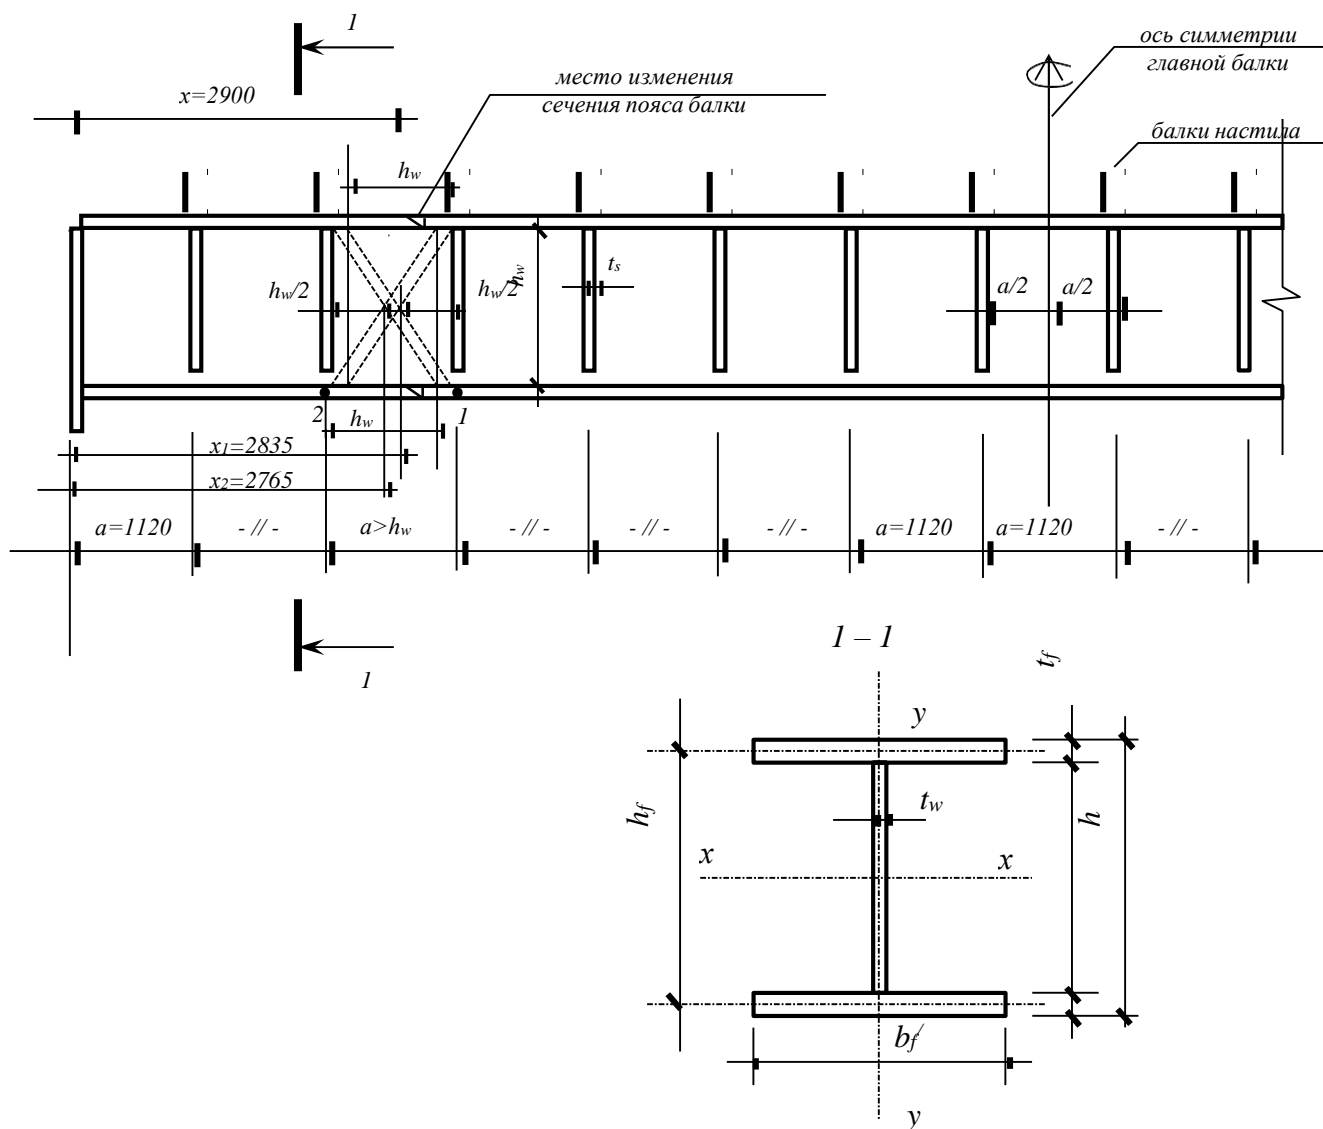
Схема размещения поперечных ребер вдоль стенки глав-ной балки, к примеру, 6.1
